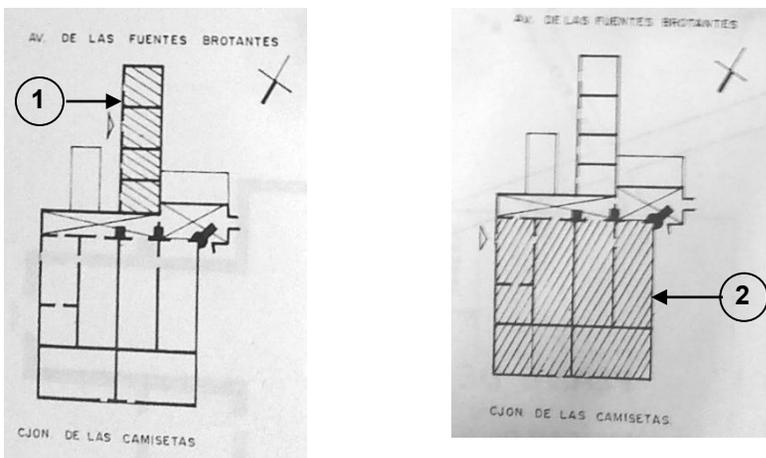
Gráfico del levantamiento Arquitectónico en planta de "El Castillo" (Por el INAH 1987)
